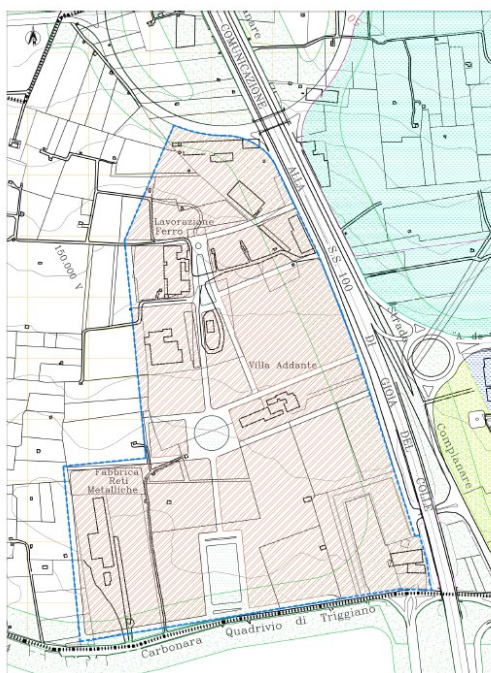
Stralcio della tavv. n.9 a 9 b "zonizzazione" del P.R.G. vigente con delimitazione della zona D1
